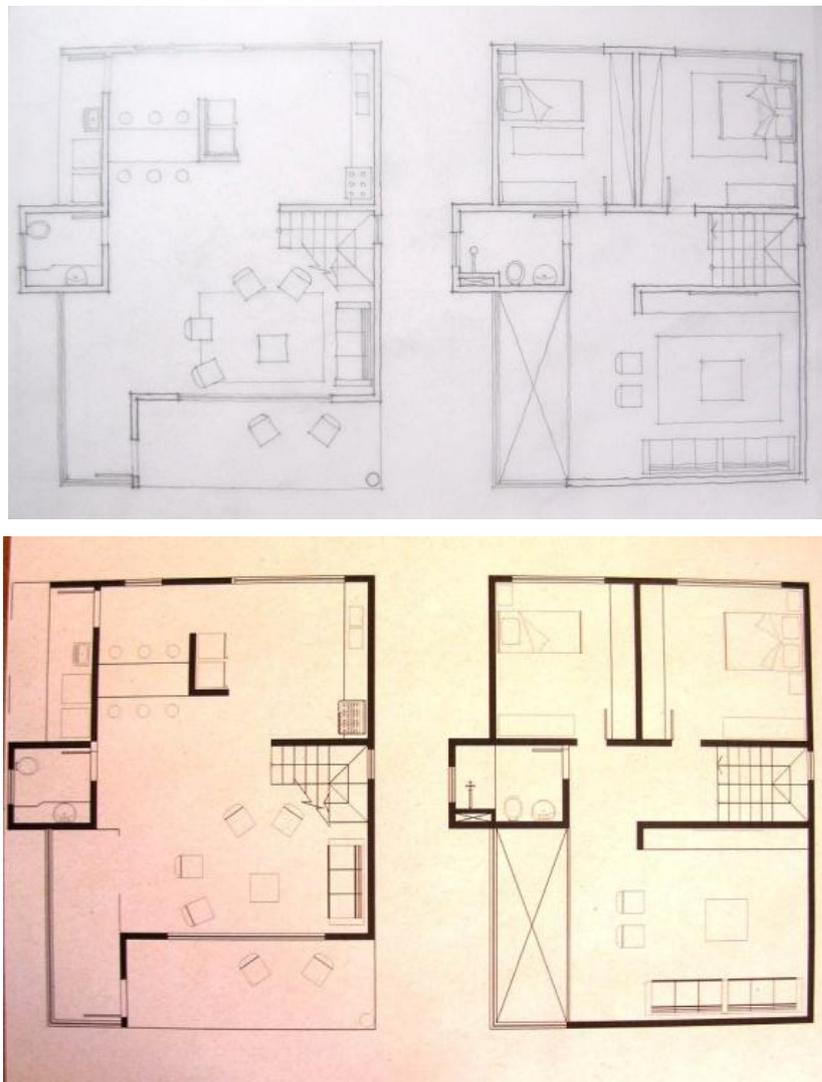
Gilfranco Alves – planta desenhada “a mão” e em CAD
